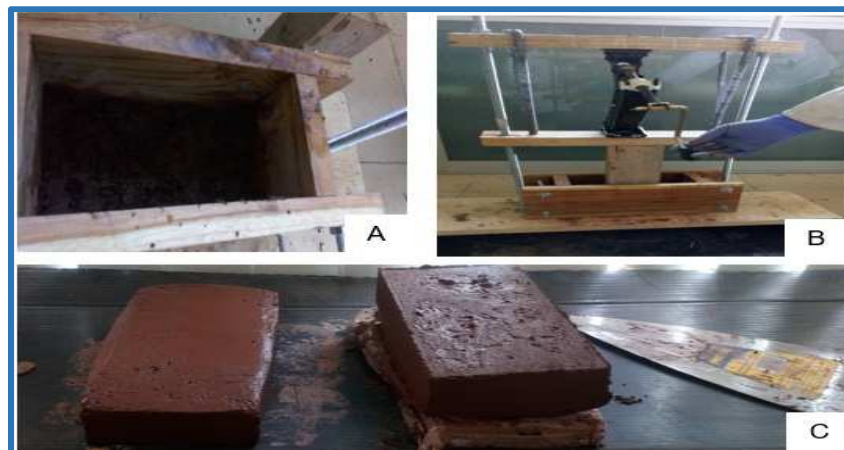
A) Molde con mezcla dentro, B) Molde montado en el dispositivo para elaborar ladrillos, C) Ladrillos después de retirar el molde
